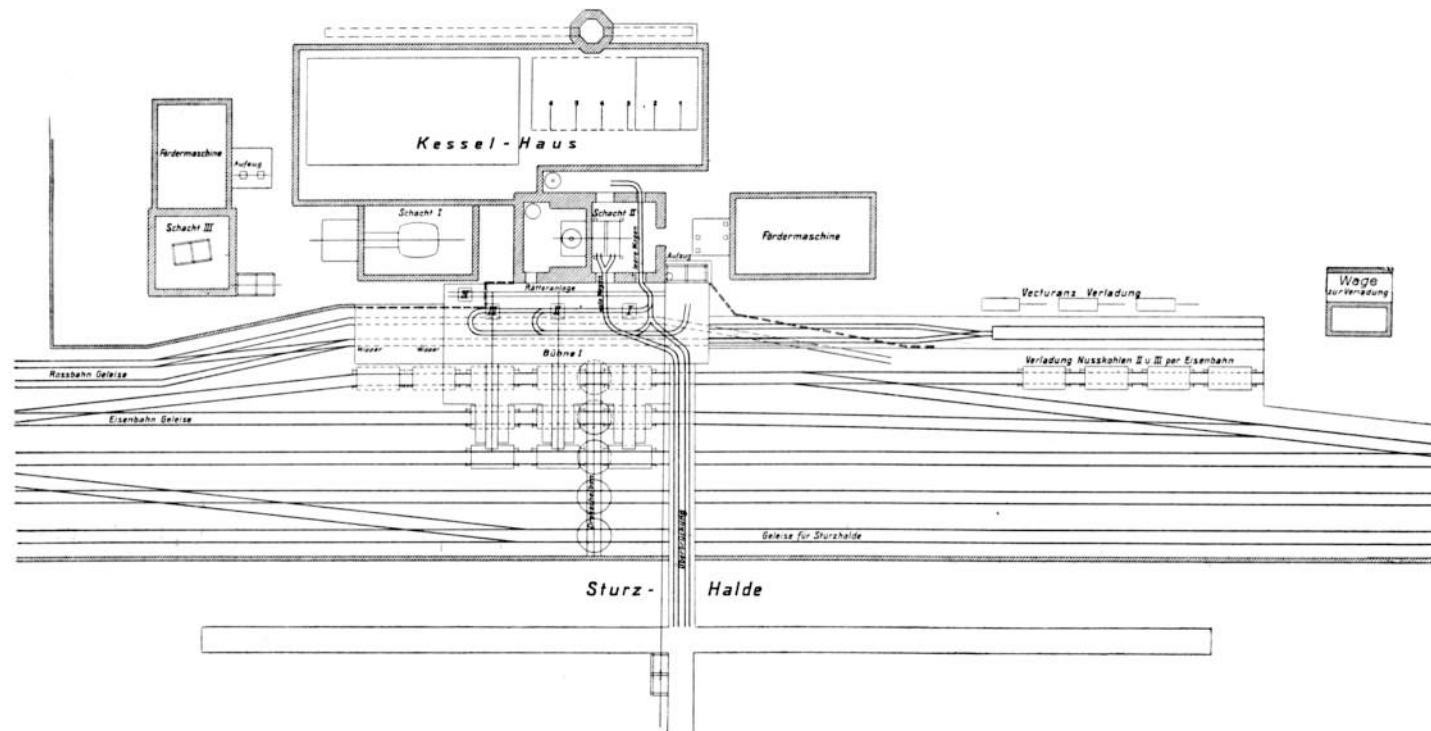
Lageplan einer oberschlesischen Steinkohlengrube aus dem Anfang der 1870er Jahre.
